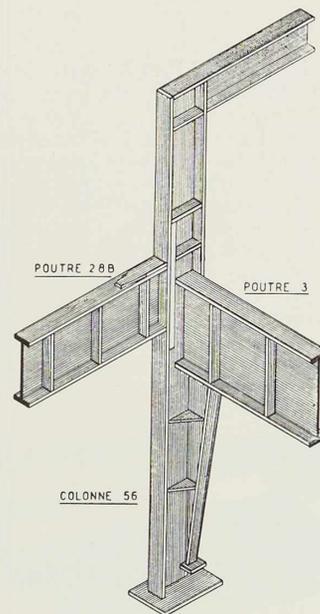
Assemblage de la colonne 56 aux poutres 3, 10 et 28.
